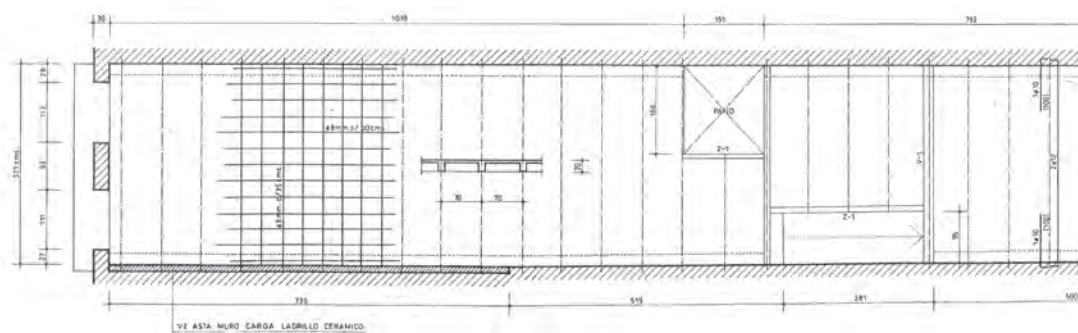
19. 1997 REFUERZO ESTRUCTURAL EN FORJADO DE SEGUNDA PLANTA
